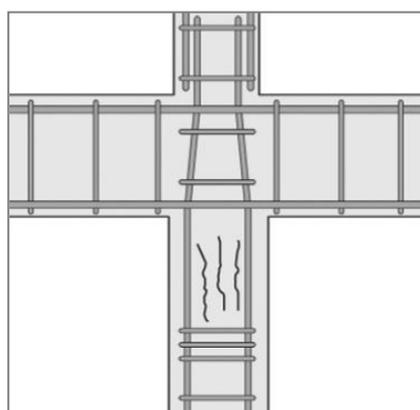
Fisuración vertical en cabeza de pilar
